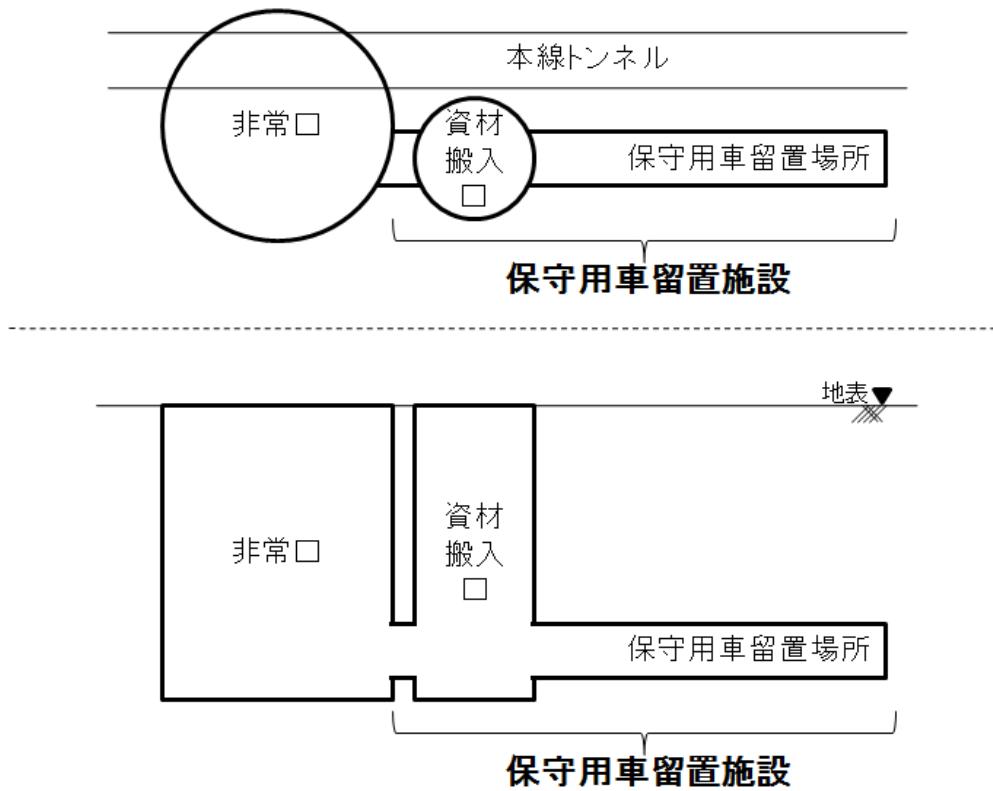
保守用車留置施設の概要（上段が平面図、下段が側面図）
